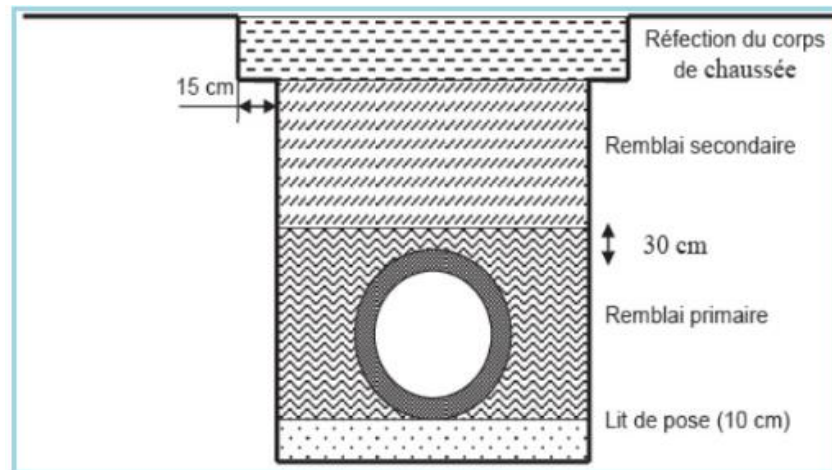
SCHEMA DE POSE DE CONDUITE DANS UN REGARD
